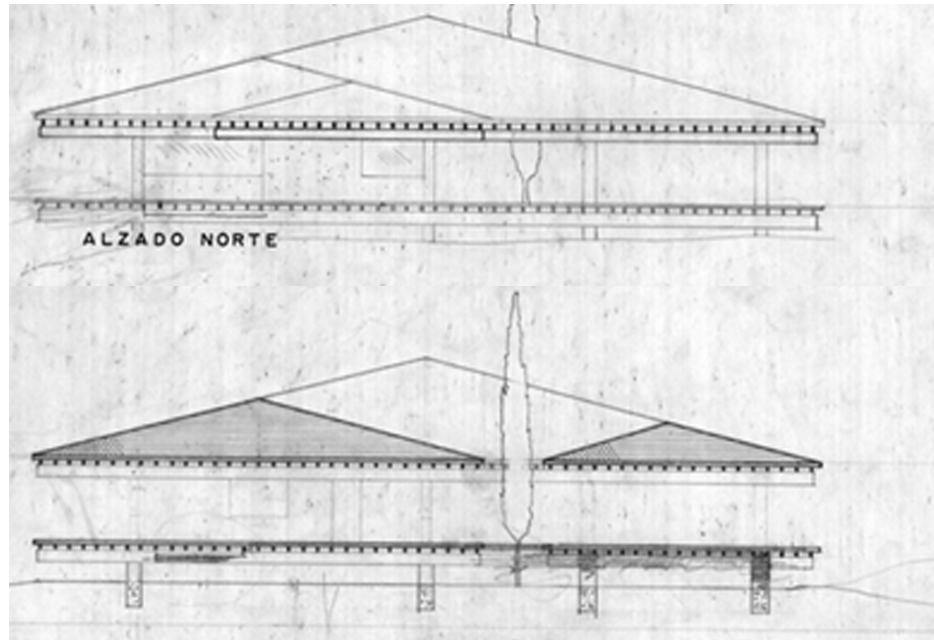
Secciones Transversales de la Casa Santonja, plano original de Higuera..
